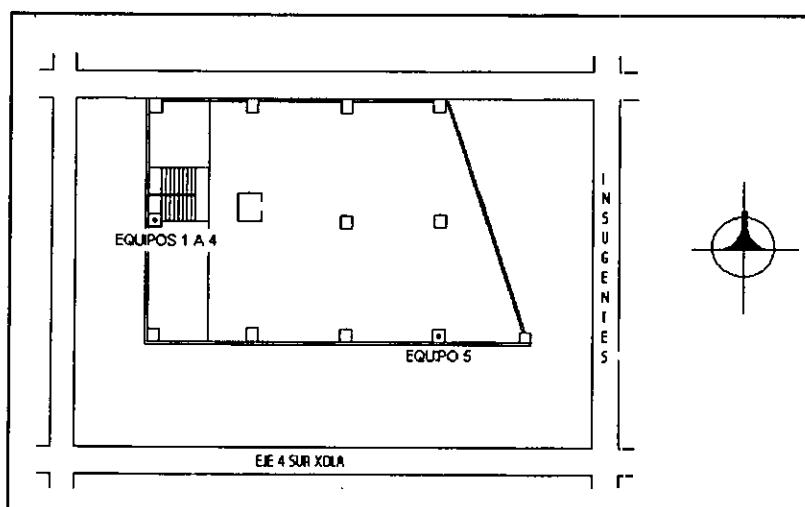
Planta tipo del edificio y ubicación de equipos de medición.
